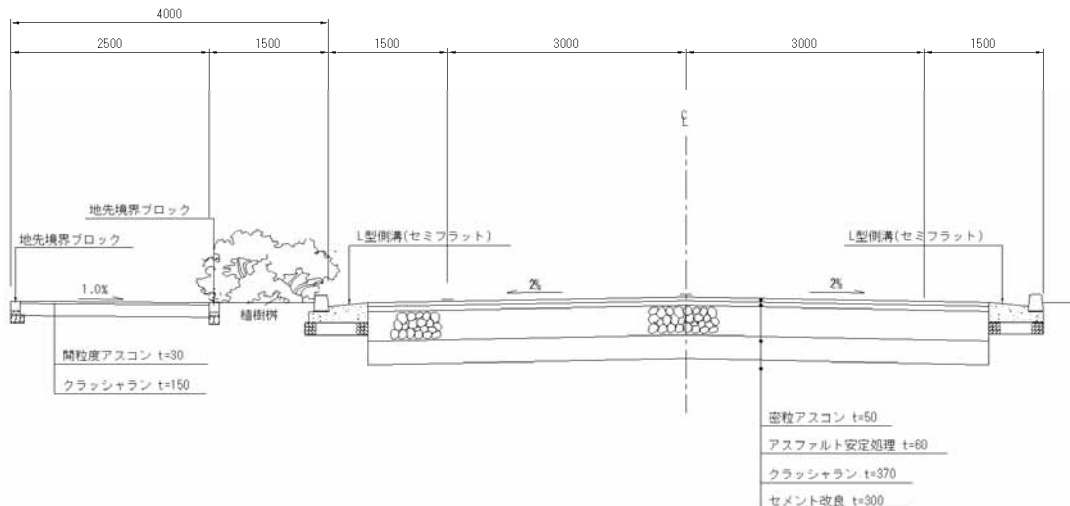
(2) 道路標準断面図（外周幹線道路）
